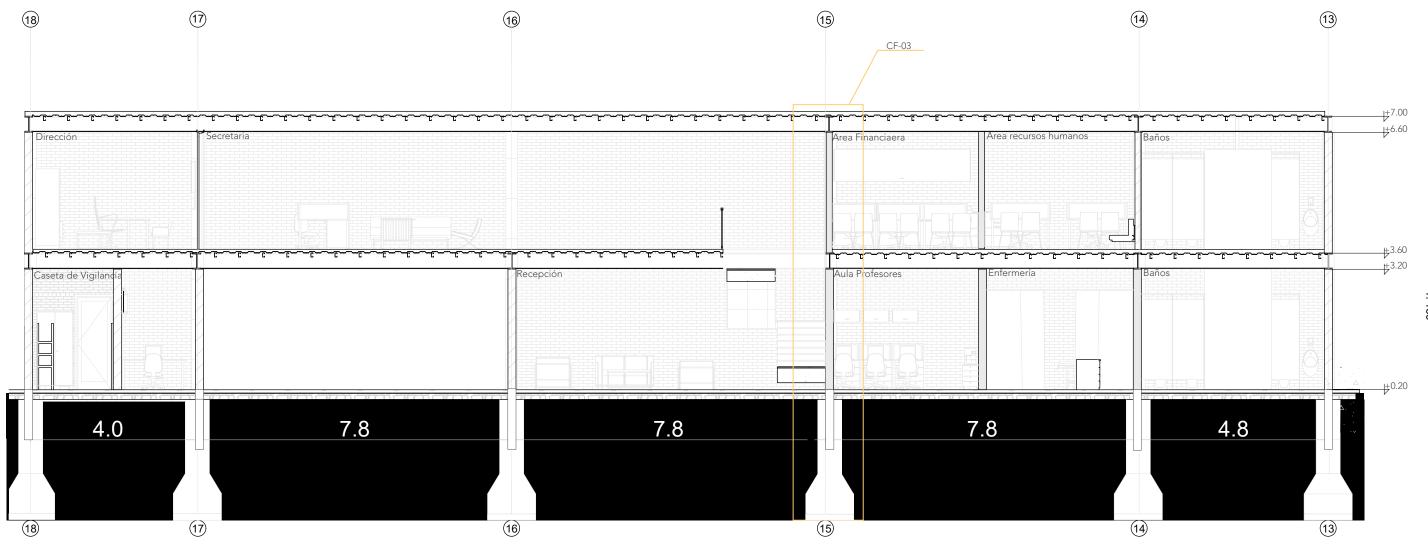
Corte Area Administración Fuente: Elaboración propia 2023.
